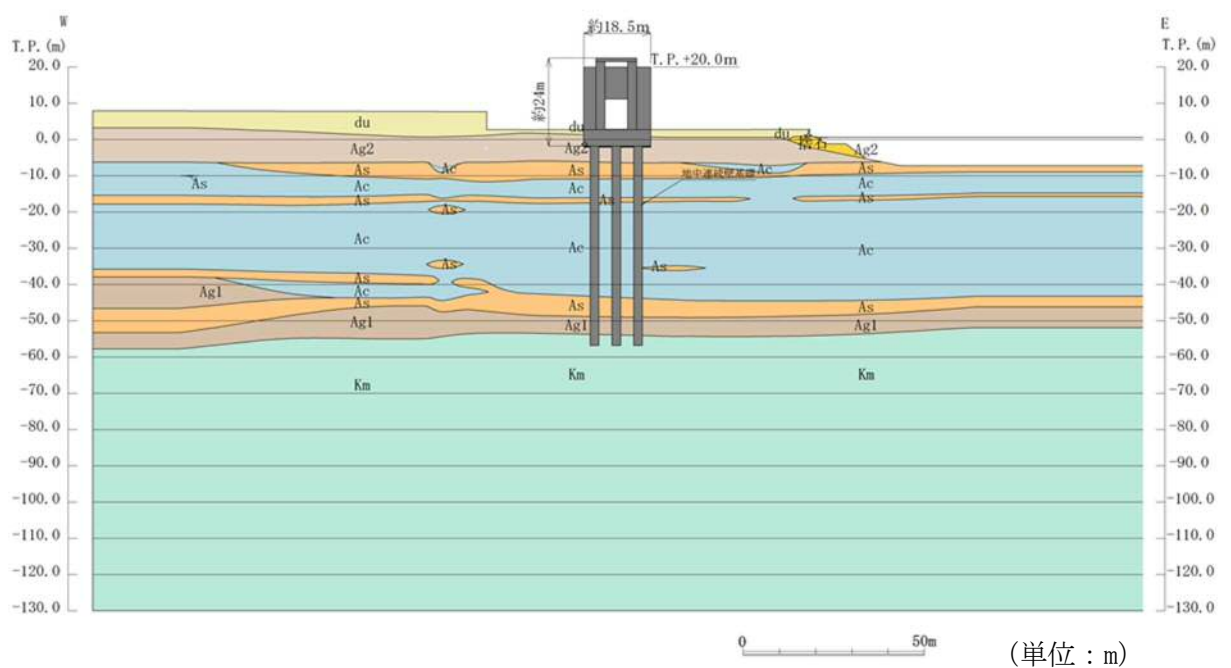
(2) 鉄筋コンクリート防潮壁 評価対象断面図 (②-②断面)
